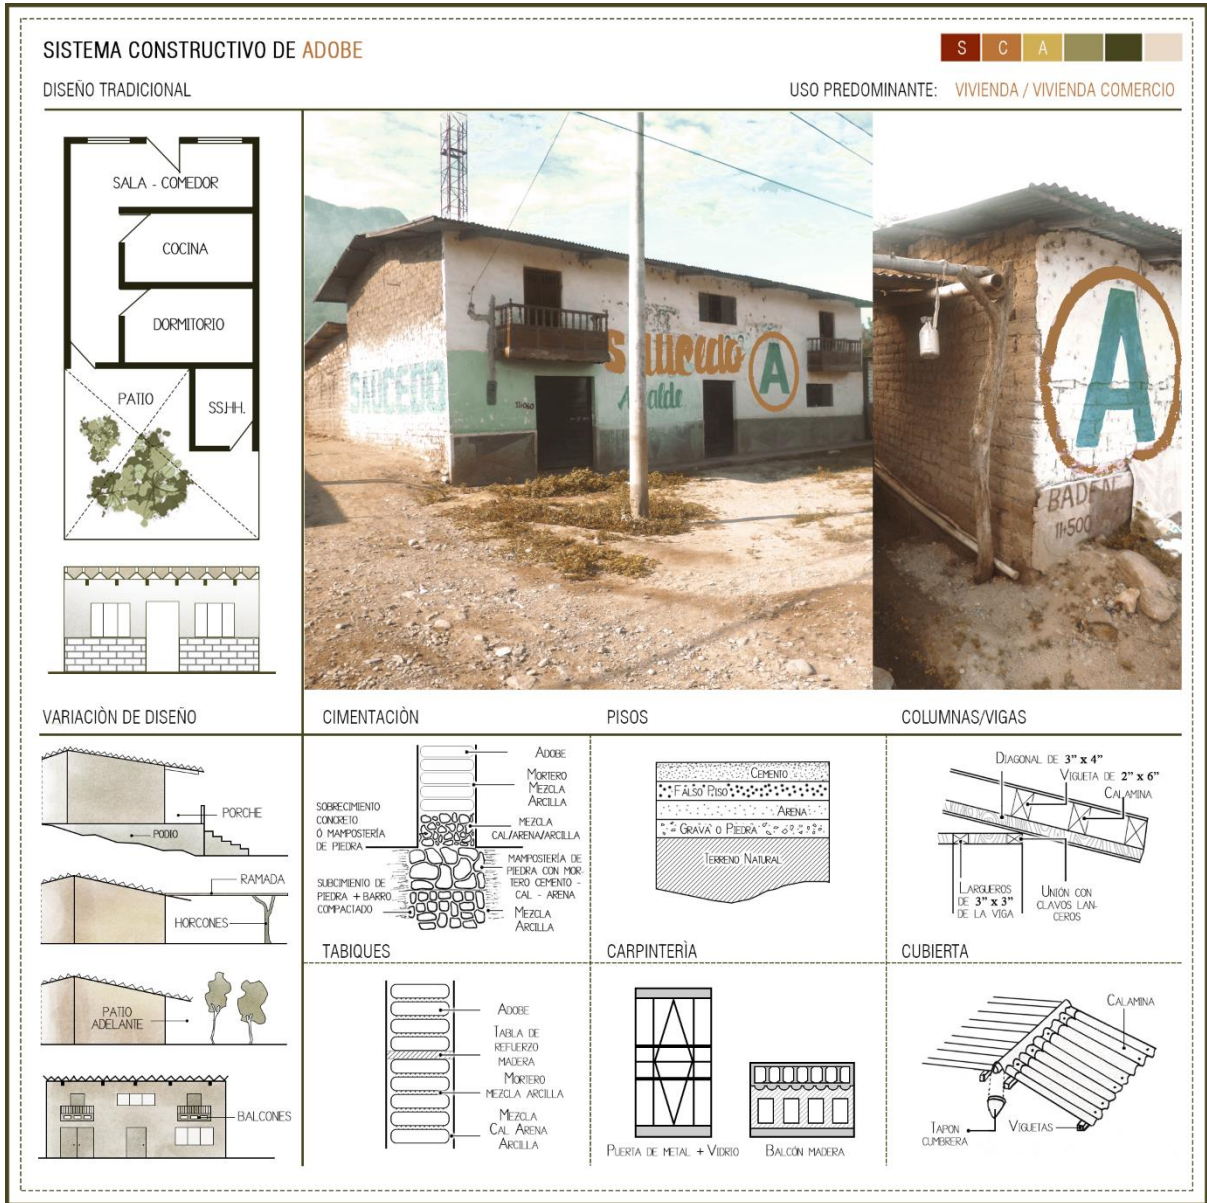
Sistema Constructivo de Adobe, Materialidad y técnicas constructivas del centro poblado. Fuente: Propia
